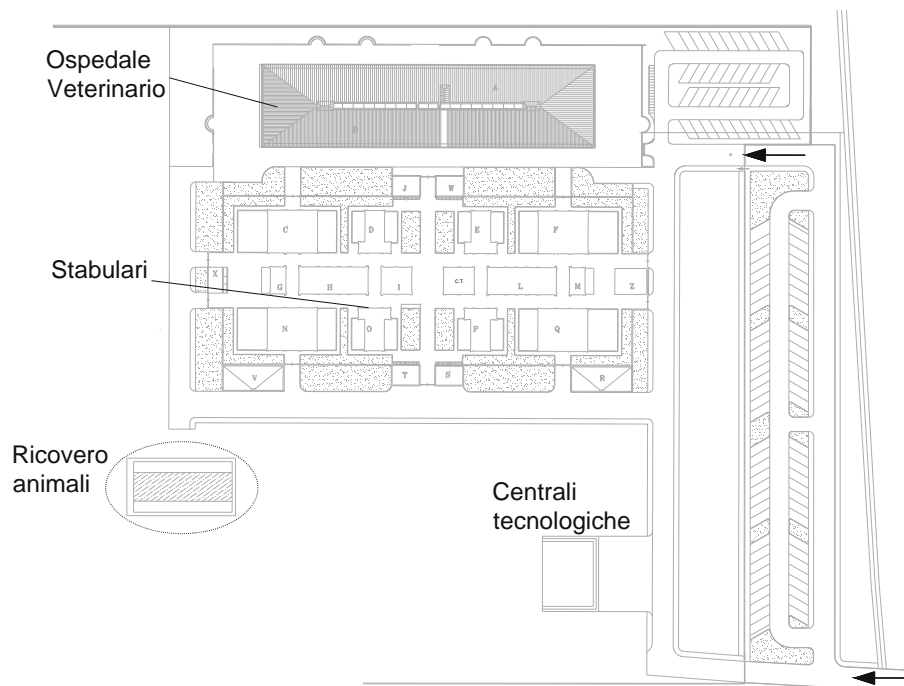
Planimetria generale dell'Ospedale Veterinario.
